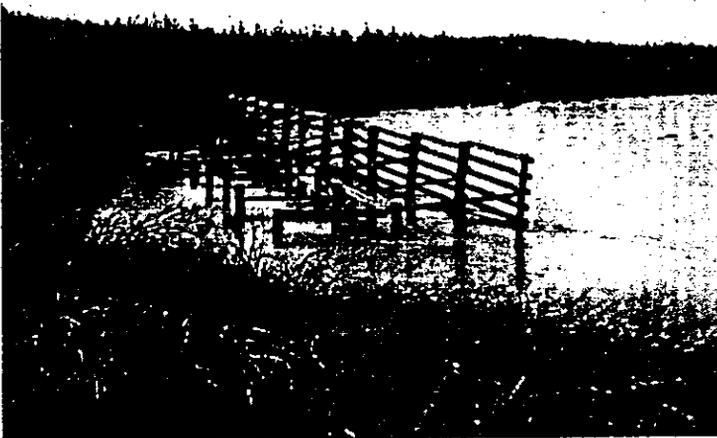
Recubrimiento permeable construido con pilotes de madera y tablones. Aun no hay vegetación y basura detenida en el espigón.
